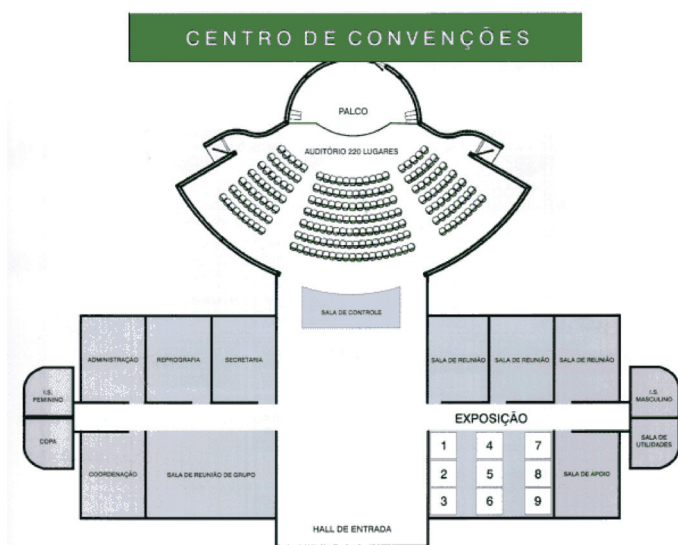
Planta baixa do Centro de Convenções Günter Hans
